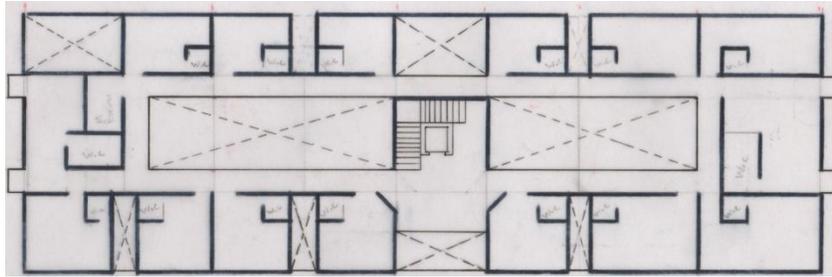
Dibujo planta Distribucion arquitectonica/ Sebastian. M
